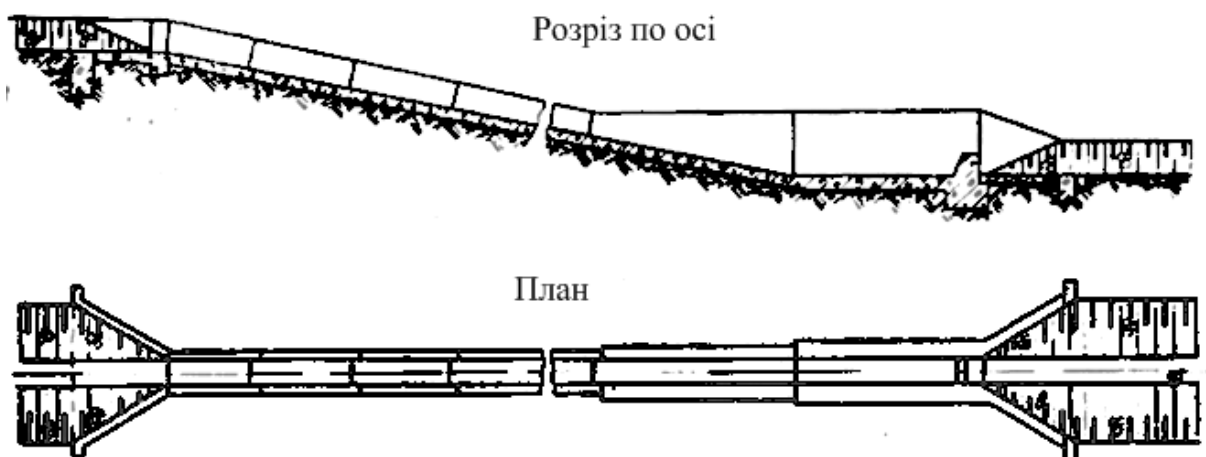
Схема бетонного швидкотоку прямокутного перетину.
